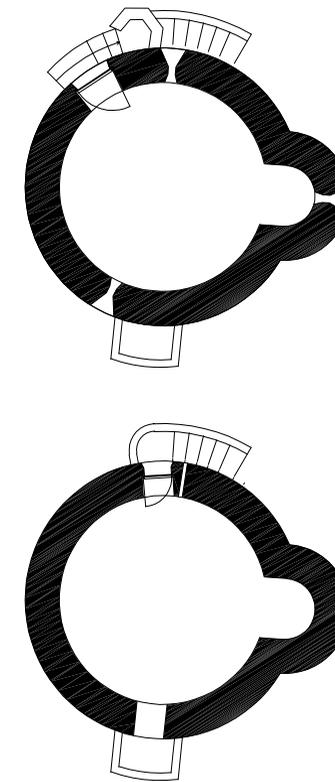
Grundrisse Leifling, M 1:200. TU Graz/Kerbitz, Gril 2010.
